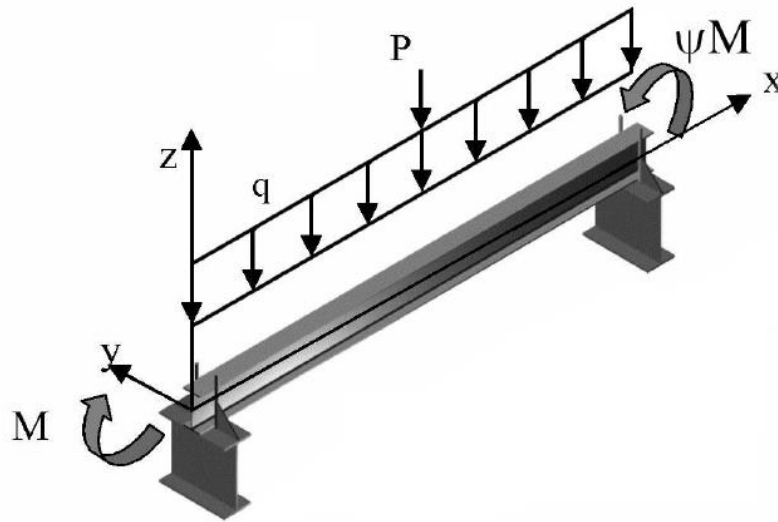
Viga simplesmente apoiada em apoios em “forquilha” (Vila Real et al., 2007a).
